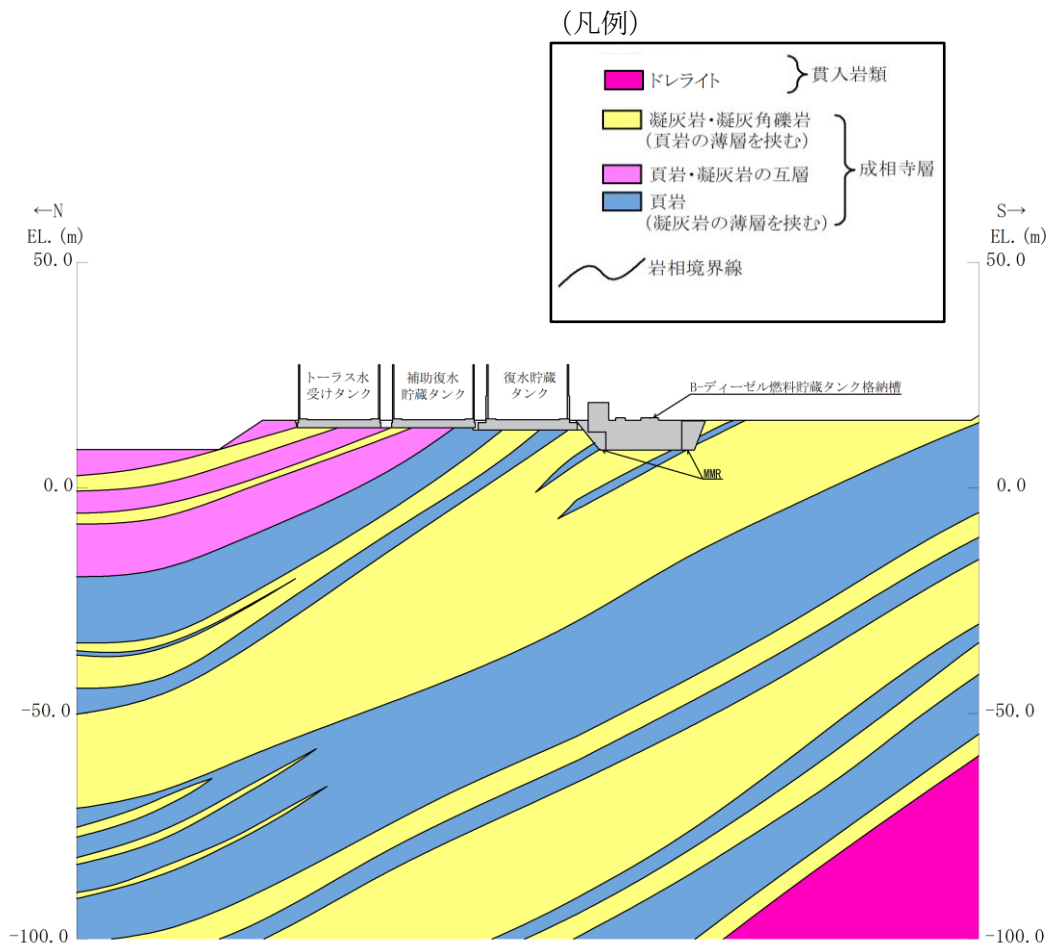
復水貯蔵タンク遮蔽壁の評価対象断面図 (A-A 断面)
